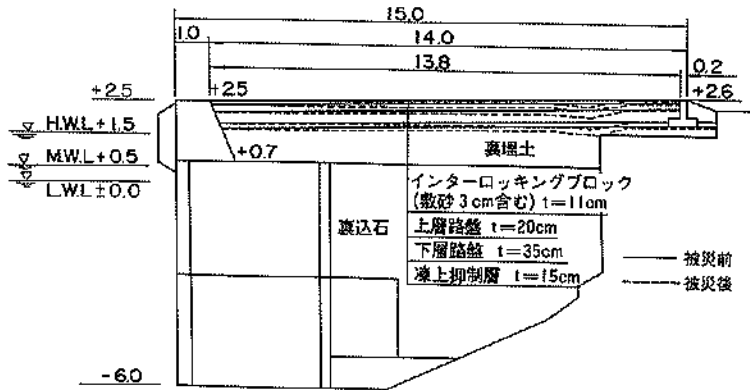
エプロン沈下断面図 (入舟地区, ④岸壁(-6.0m))
